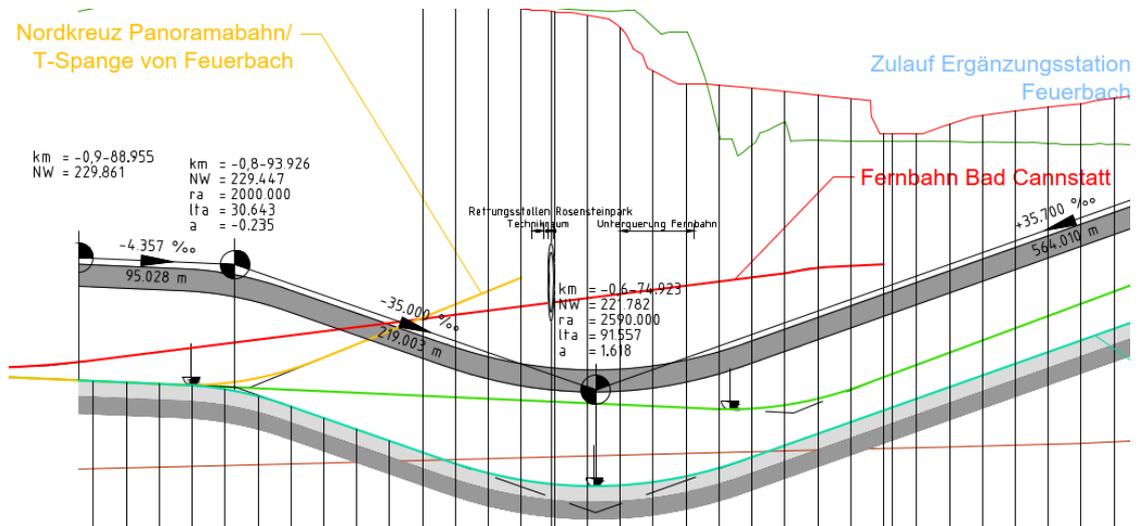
Längsschnitt Gleis nach Bad Cannstatt im Bereich der Unterquerung von Rettungsstollen und Fernbahntunnel (siehe Anlage 4.2)
